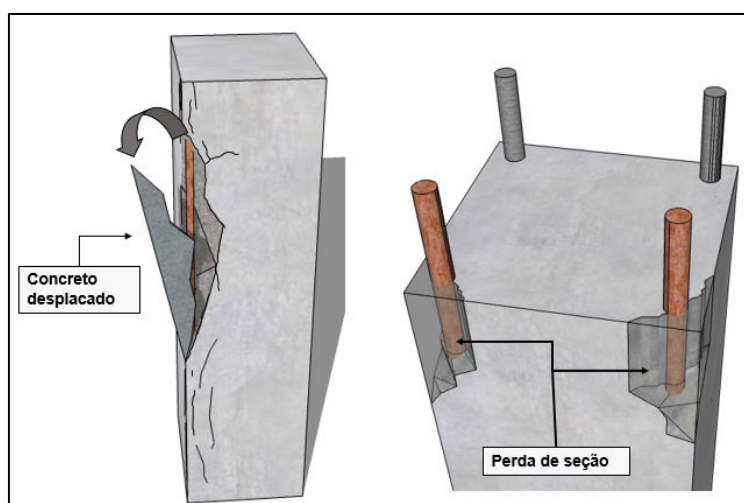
Ilustração do processo de corrosão, perda da seção das armaduras e consequente deslocamento do concreto
